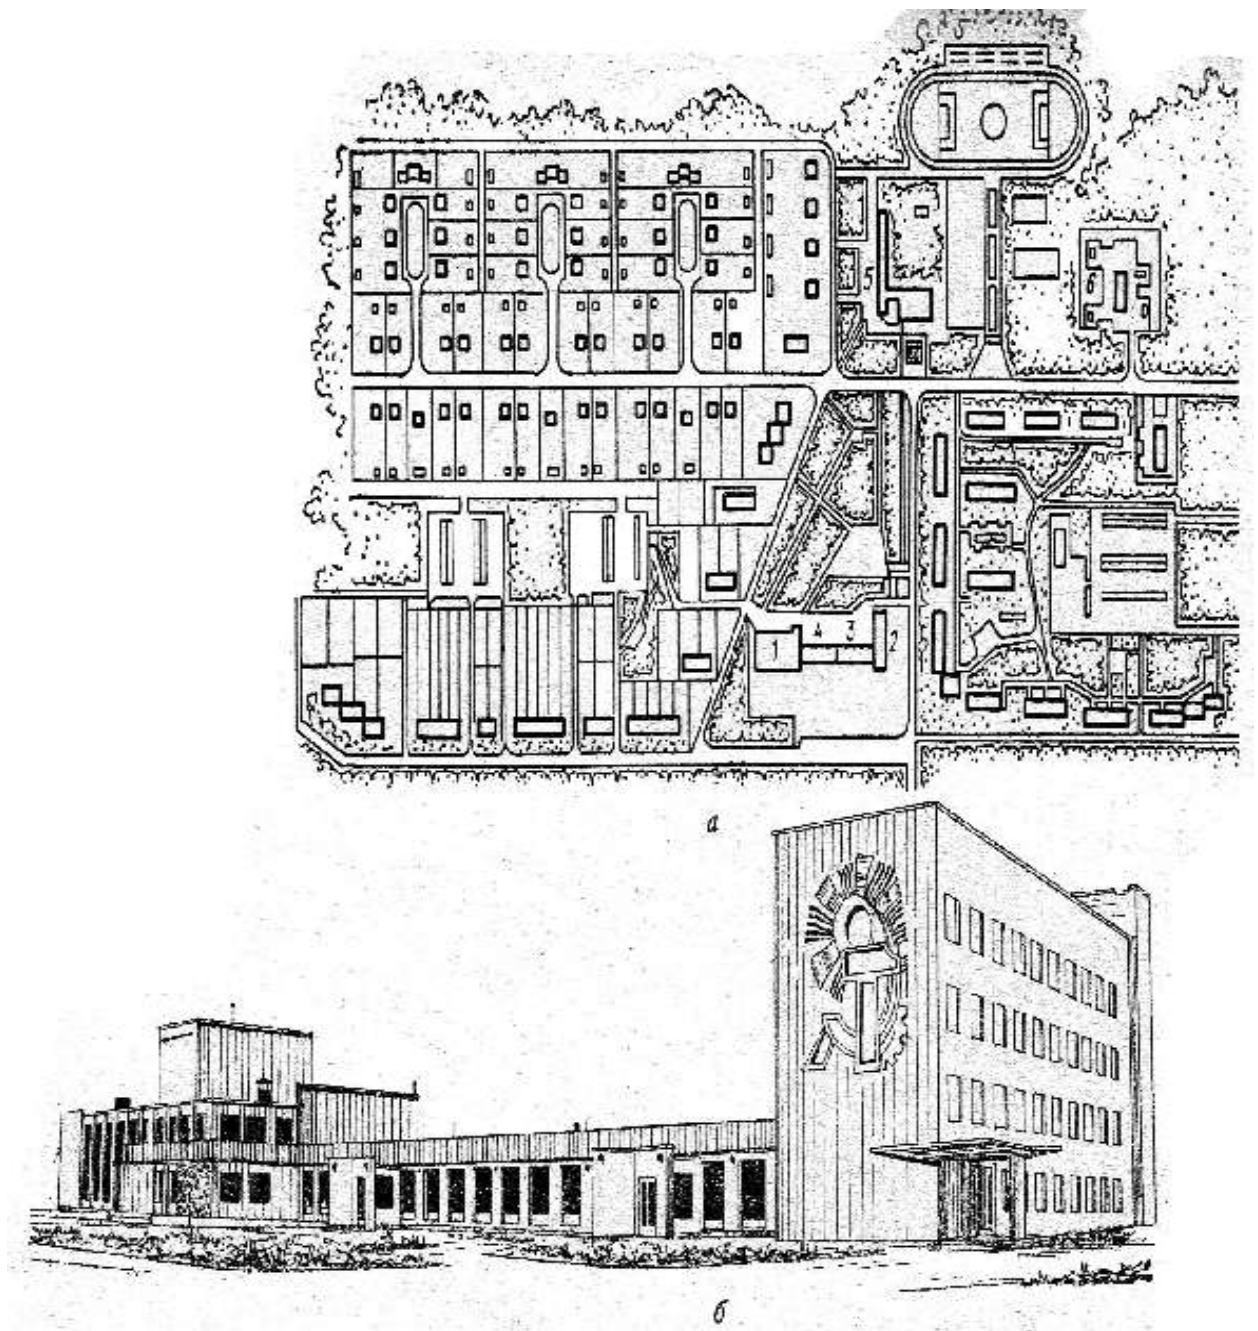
Общественный центр поселка: а — схема генплана: 1 — клуб, библиотека; 2 — административно-бытовой блок; 3 — столовая; 4 — магазин; 5 — школа; 6 — детский сад; б — общий вид.
